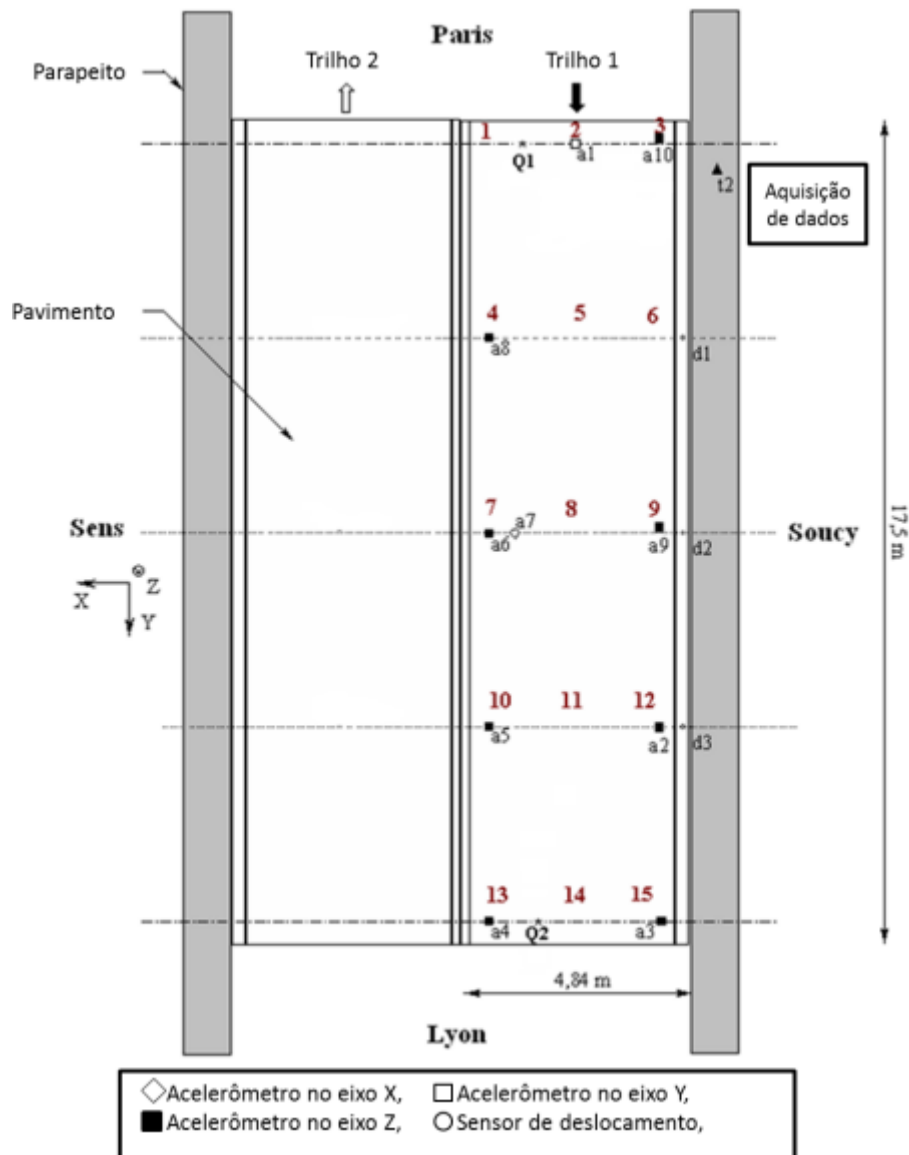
Disposição dos sensores sob o pavimento. Fonte – Cury, 2010.
